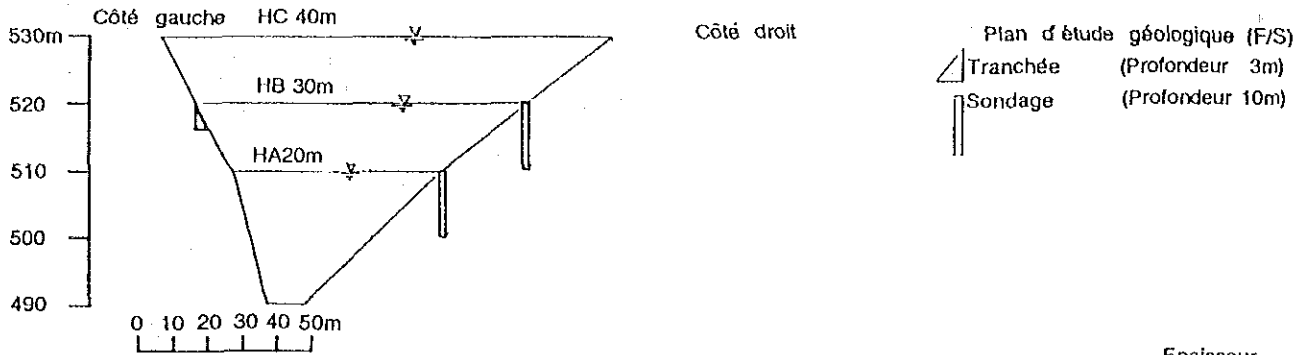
Géologie du site du barrage P-C-5
